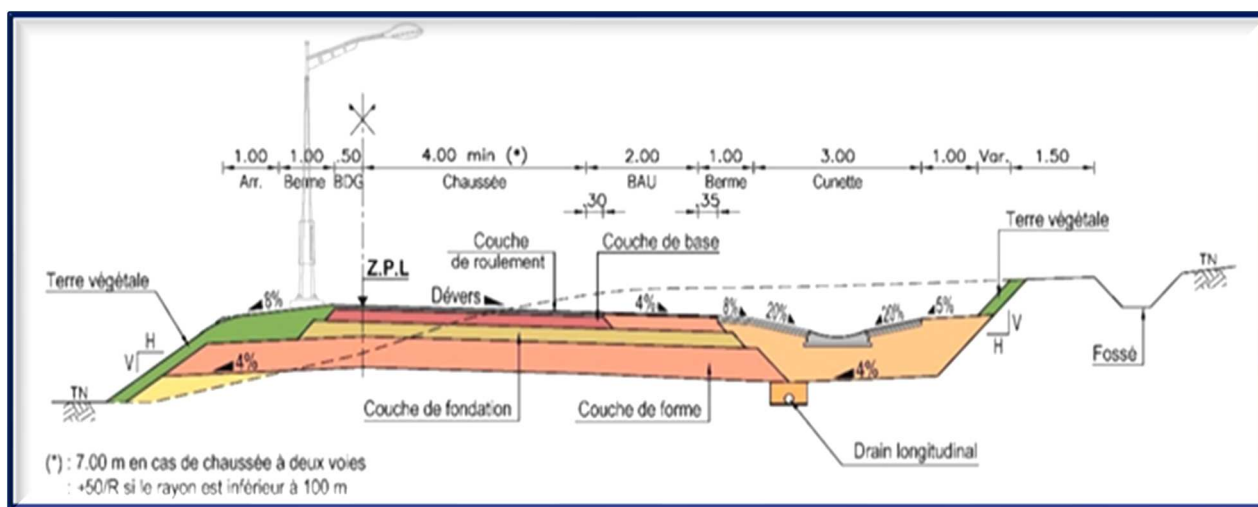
Profil en travers type des bretelles et branches unidirectionnelles
